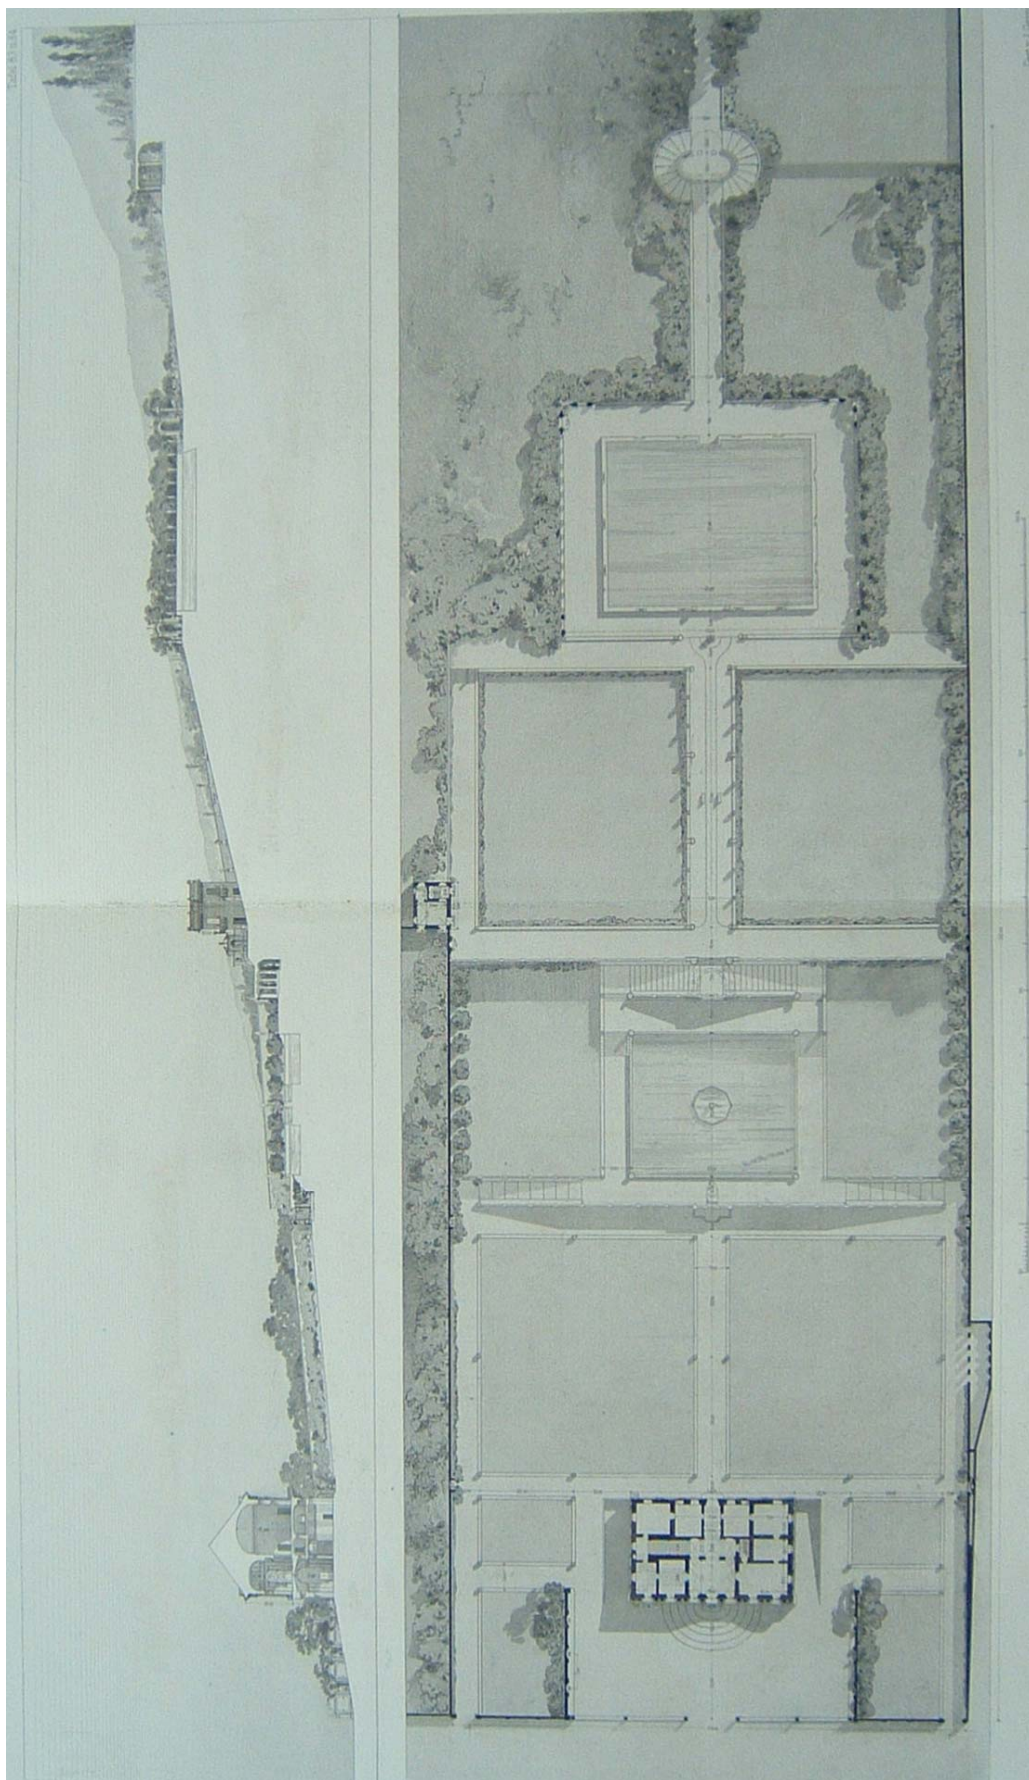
Pianta e sezione di Villa Imperiale Scassi con la sistemazione esterna (da R. Reinhardt 1886, tav. 83-84).
